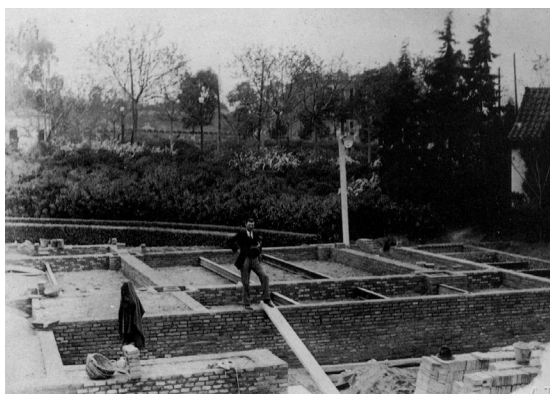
Hallazgo de la cimentación del Pabellón Alemán (1986)
